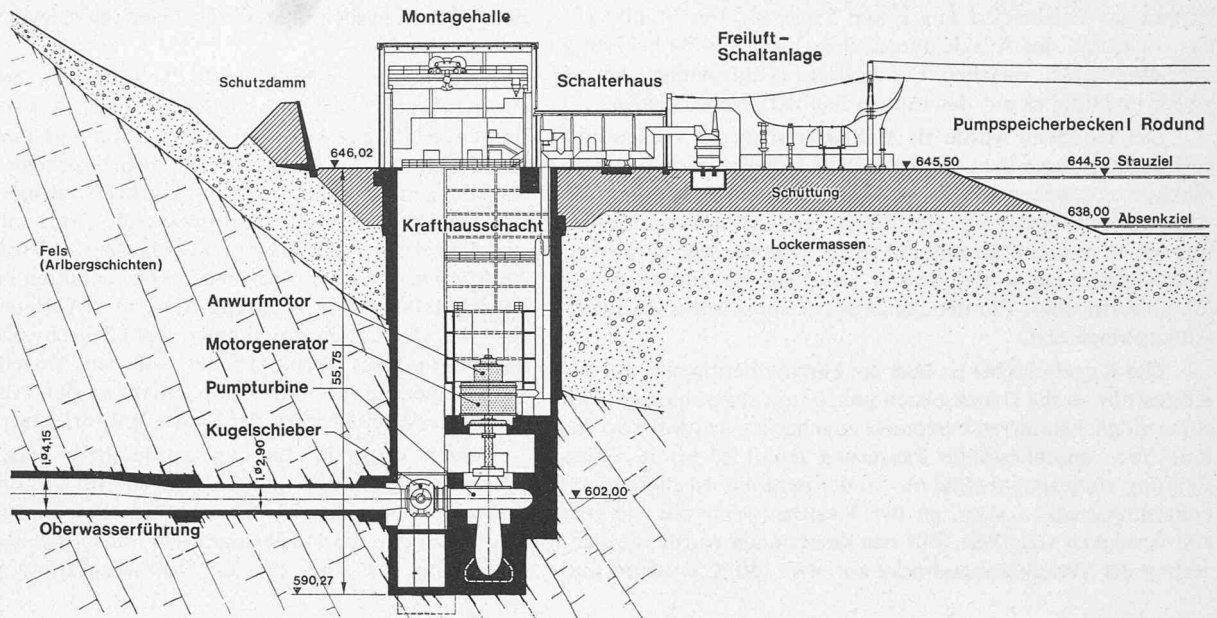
Längenschnitt durch Krafthauschacht mit Oberwasserführung, 1:1000
